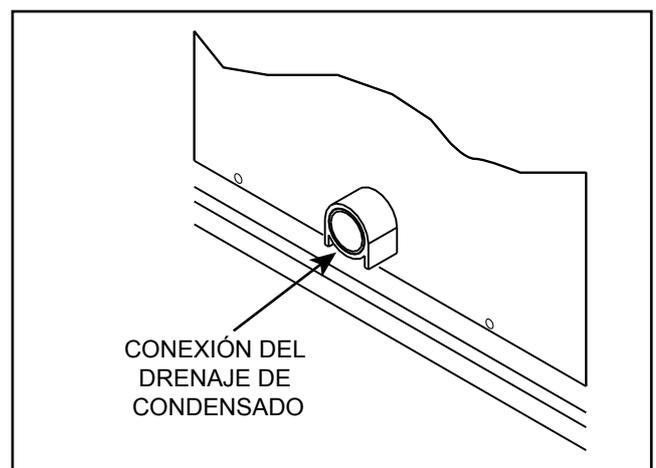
Conexión de la bandeja del drenaje de condensado
